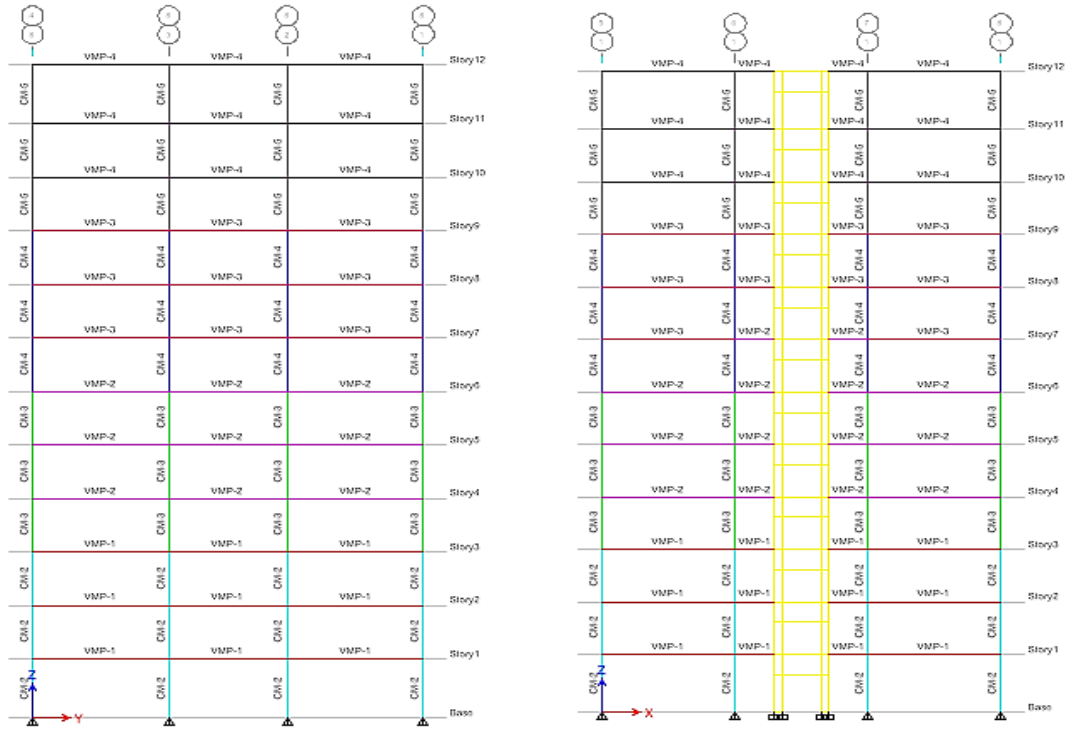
Vista de elevación estructural de la estructura A, Ejes 1 y 8 respectivamente.
